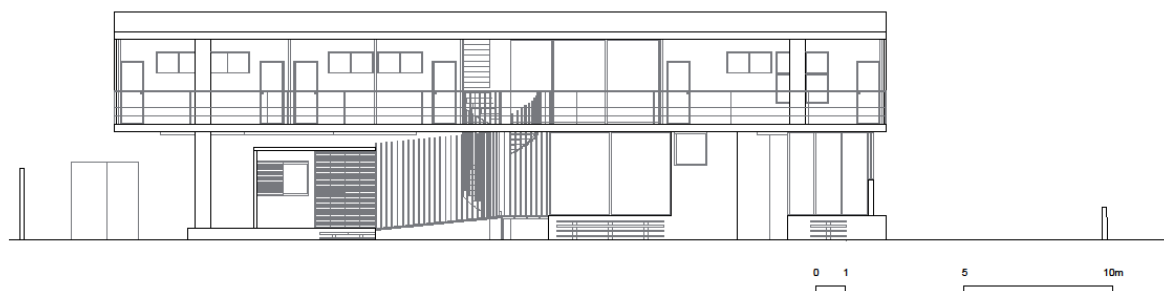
Elevação norte (vista posterior). Fonte: AUTOR (2017).
